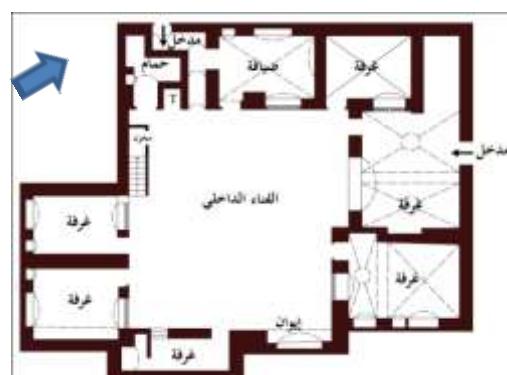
مسقّط الدور الأرضي بيت العمصي، حي الدرج
